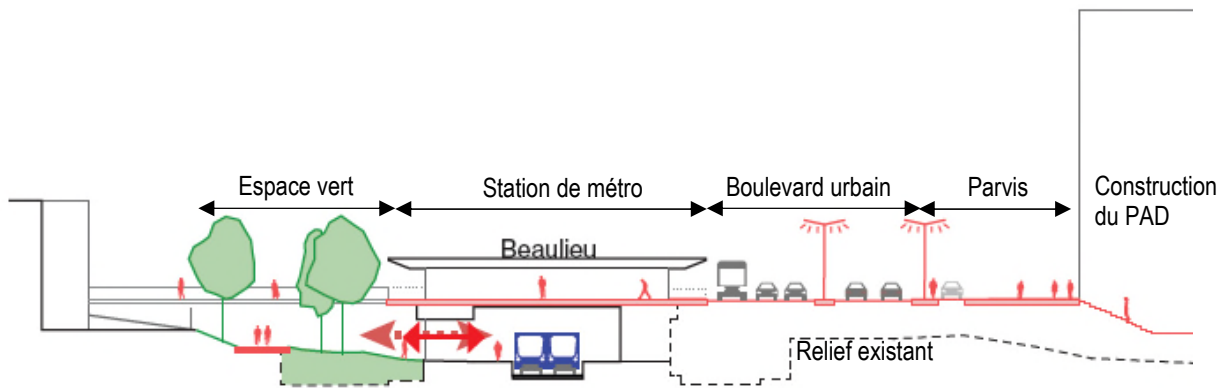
Profil de la place Beaulieu (ARIES sur fond ORG², 2018)
